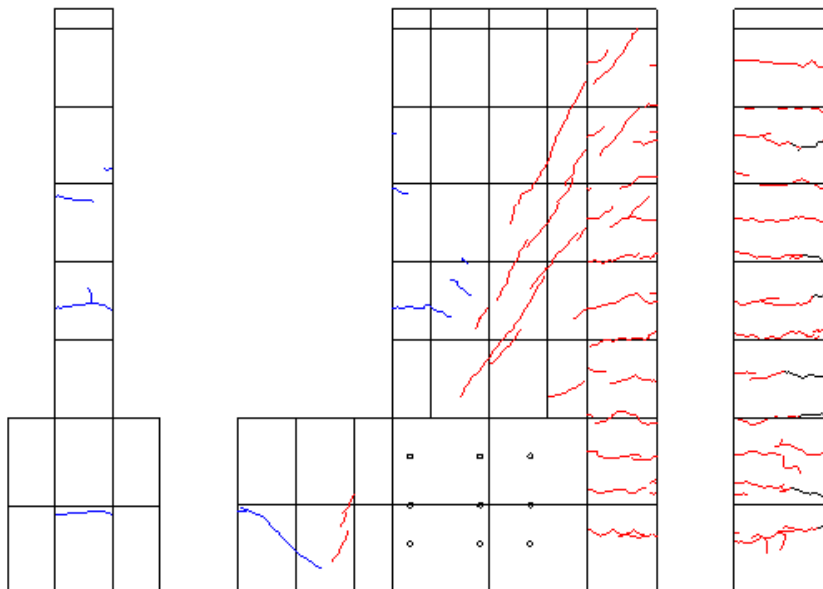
R=-1/200②ひび割れ図
